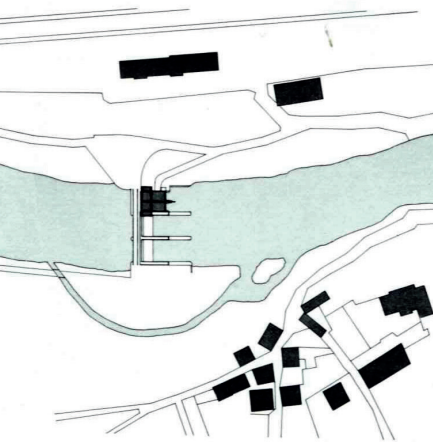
Lageplan des Kraftwerks an der Mur
